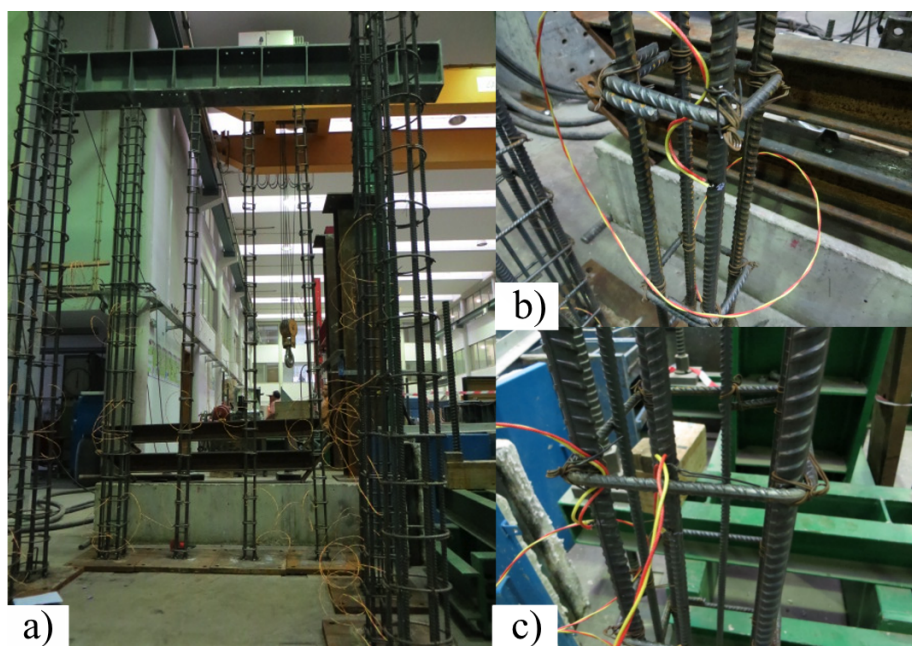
Instrumentação das armaduras: a) Vista geral das armaduras; b) Pormenor de termopares soldados à secção com 150 mm de lado; c) Pormenor de termopares soldados à secção com 220 mm de lado
